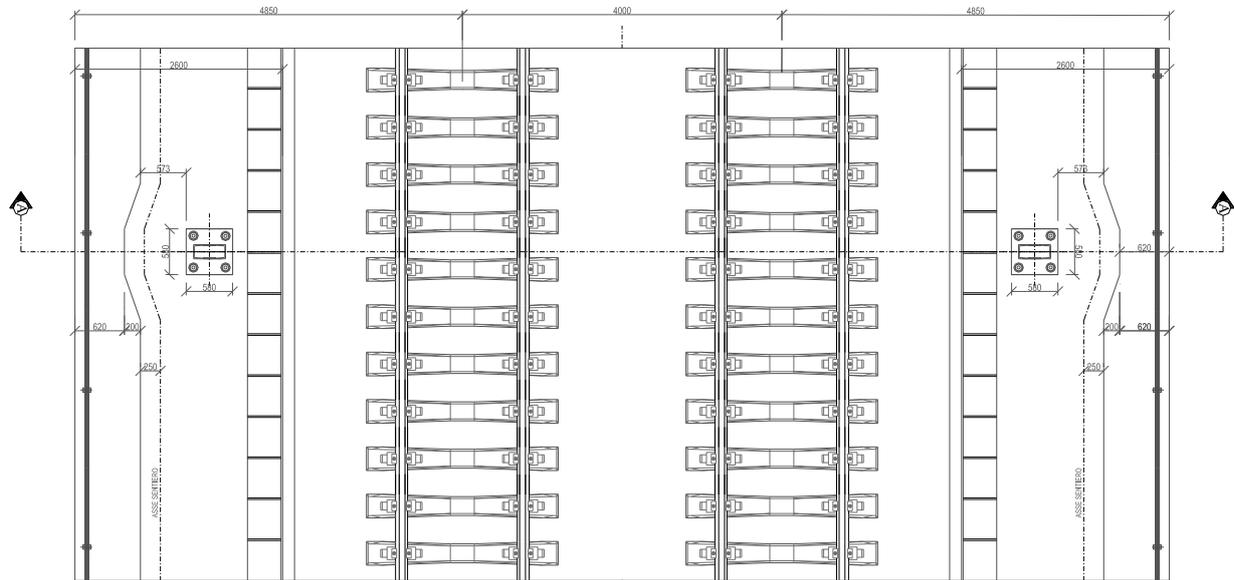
Stralcio planimetrico sezione tipo ferroviaria in viadotto a doppio binario
